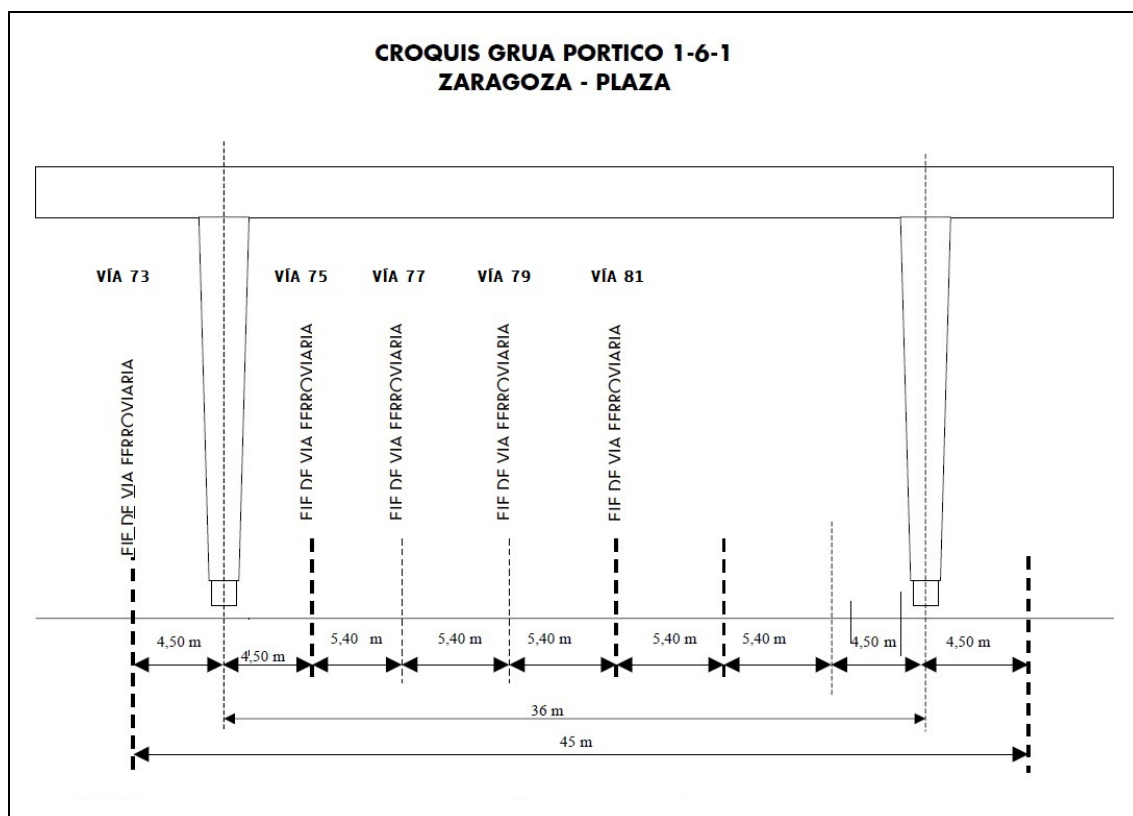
Croquis grúa pórtico 1-6-1 C.L. Zaragoza Plaza
